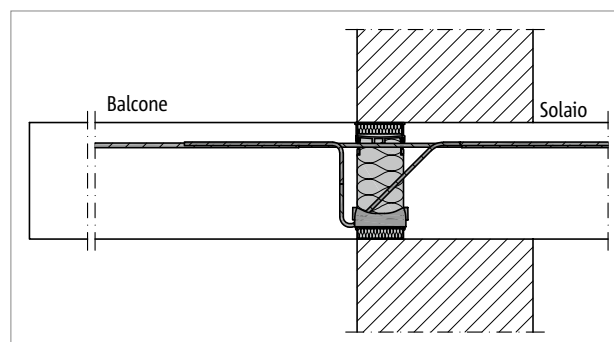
Schöck Isokorb® T tipo KL: raccordo del balcone con muratura monostrato isolante
